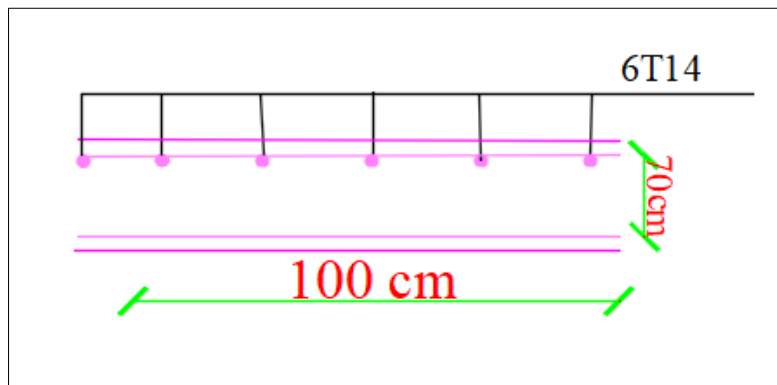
Coupe A-A ferrailage du panneau du radier sens x-x et y-y
